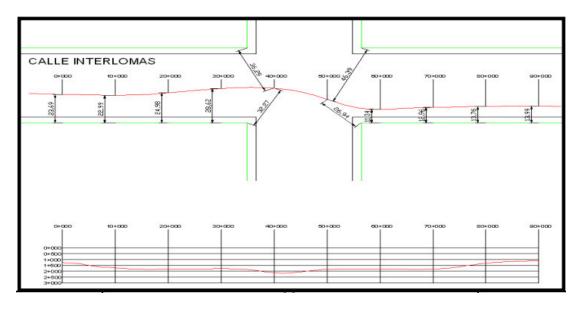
Perfil longitudinal y detalle del cruce a realizar.
